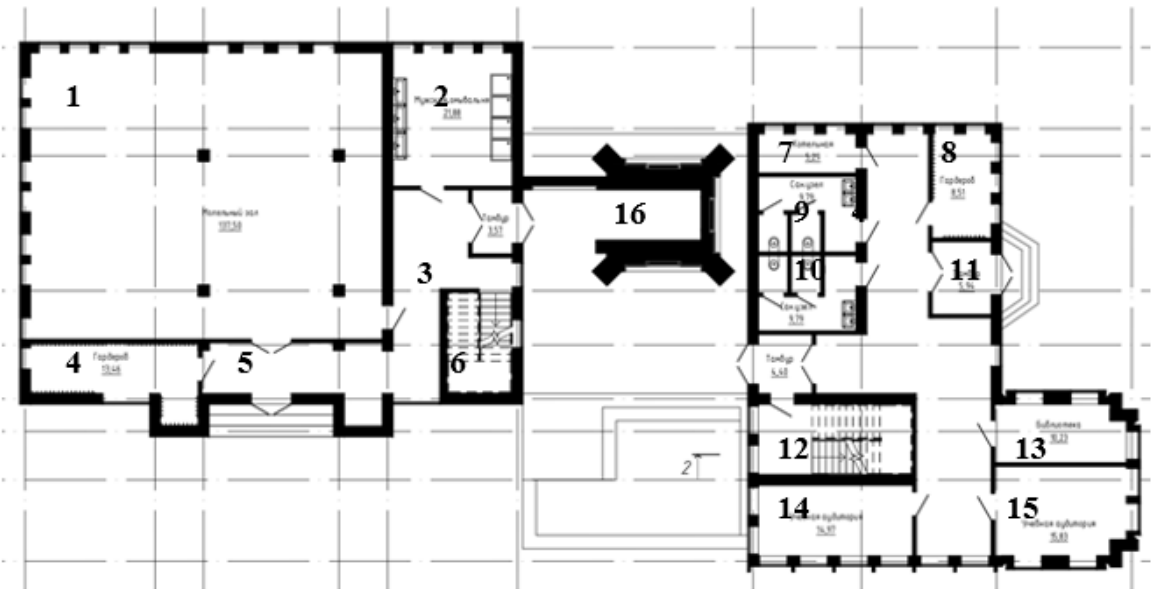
Схема плана первого этажа комплекса мечети: 1 – мужской моляльный зал; 2 – мужская комната для омовения; 3 – коридор; 4 – гардероб; 5 – холл; 6 – лестница; 7 – котельная; 8 – гардероб; 9, 10 – санузел; 11 – тамбур; 12 – лестница; 13 – библиотека; 14, 15 – учебные аудитории; 16 – минарет
